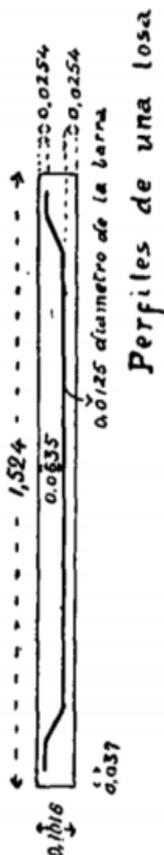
Losa prefabricada de hormigón armado (Revista Militar, 1920)
